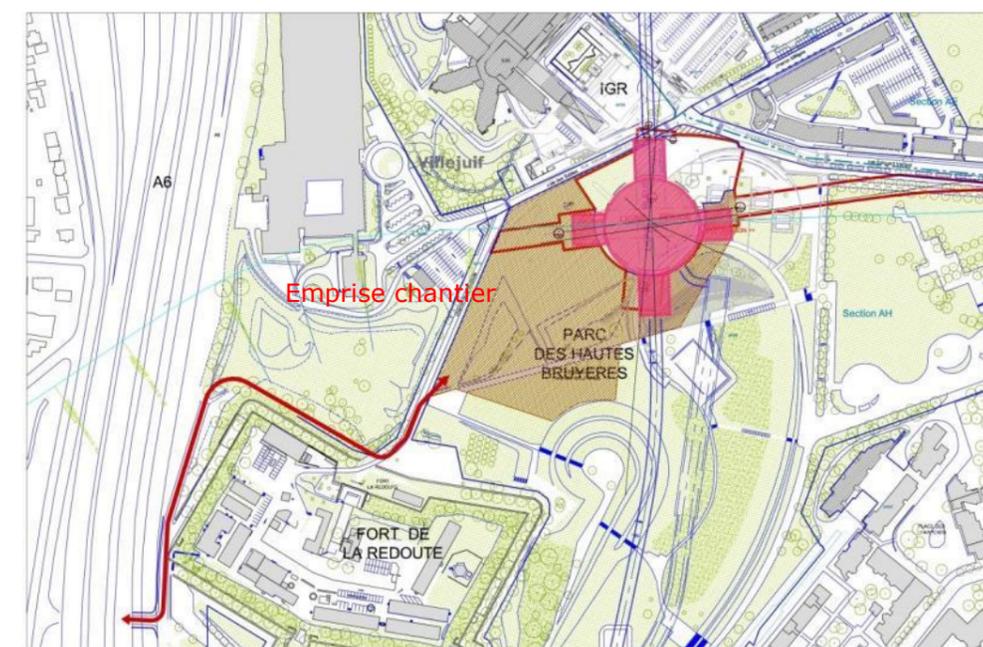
Gare de Villejuif IGR – Plan d'emprise chantier
